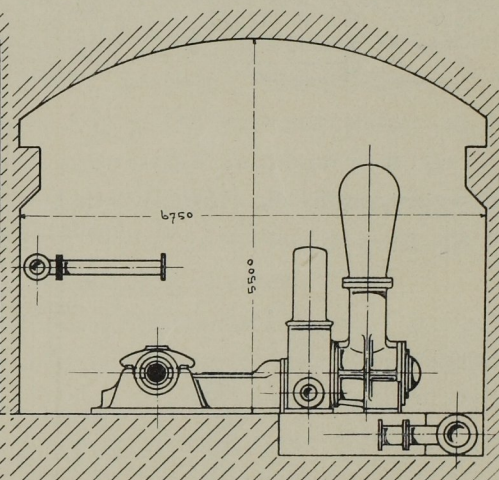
Grundriss der Maschinenanlage. Masst. 1:100.
